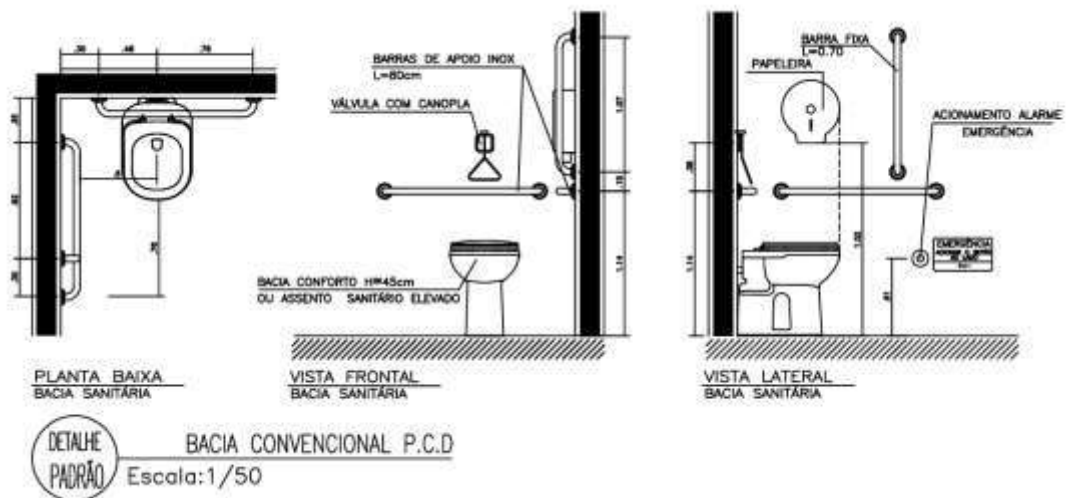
Detalhe das barras de apoio para banheiro PNE (sem escala)
